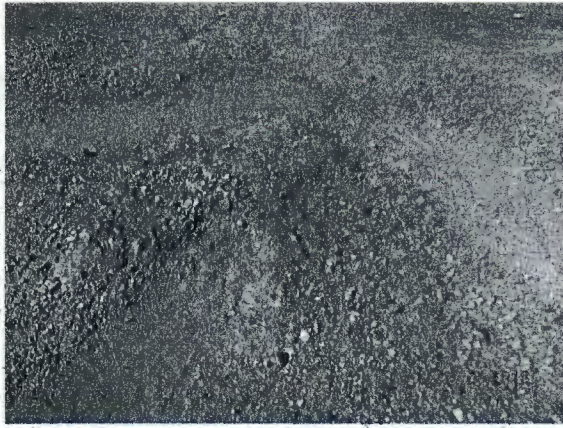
Restos de hormigón sobre la calzada de concreto asfáltico.
